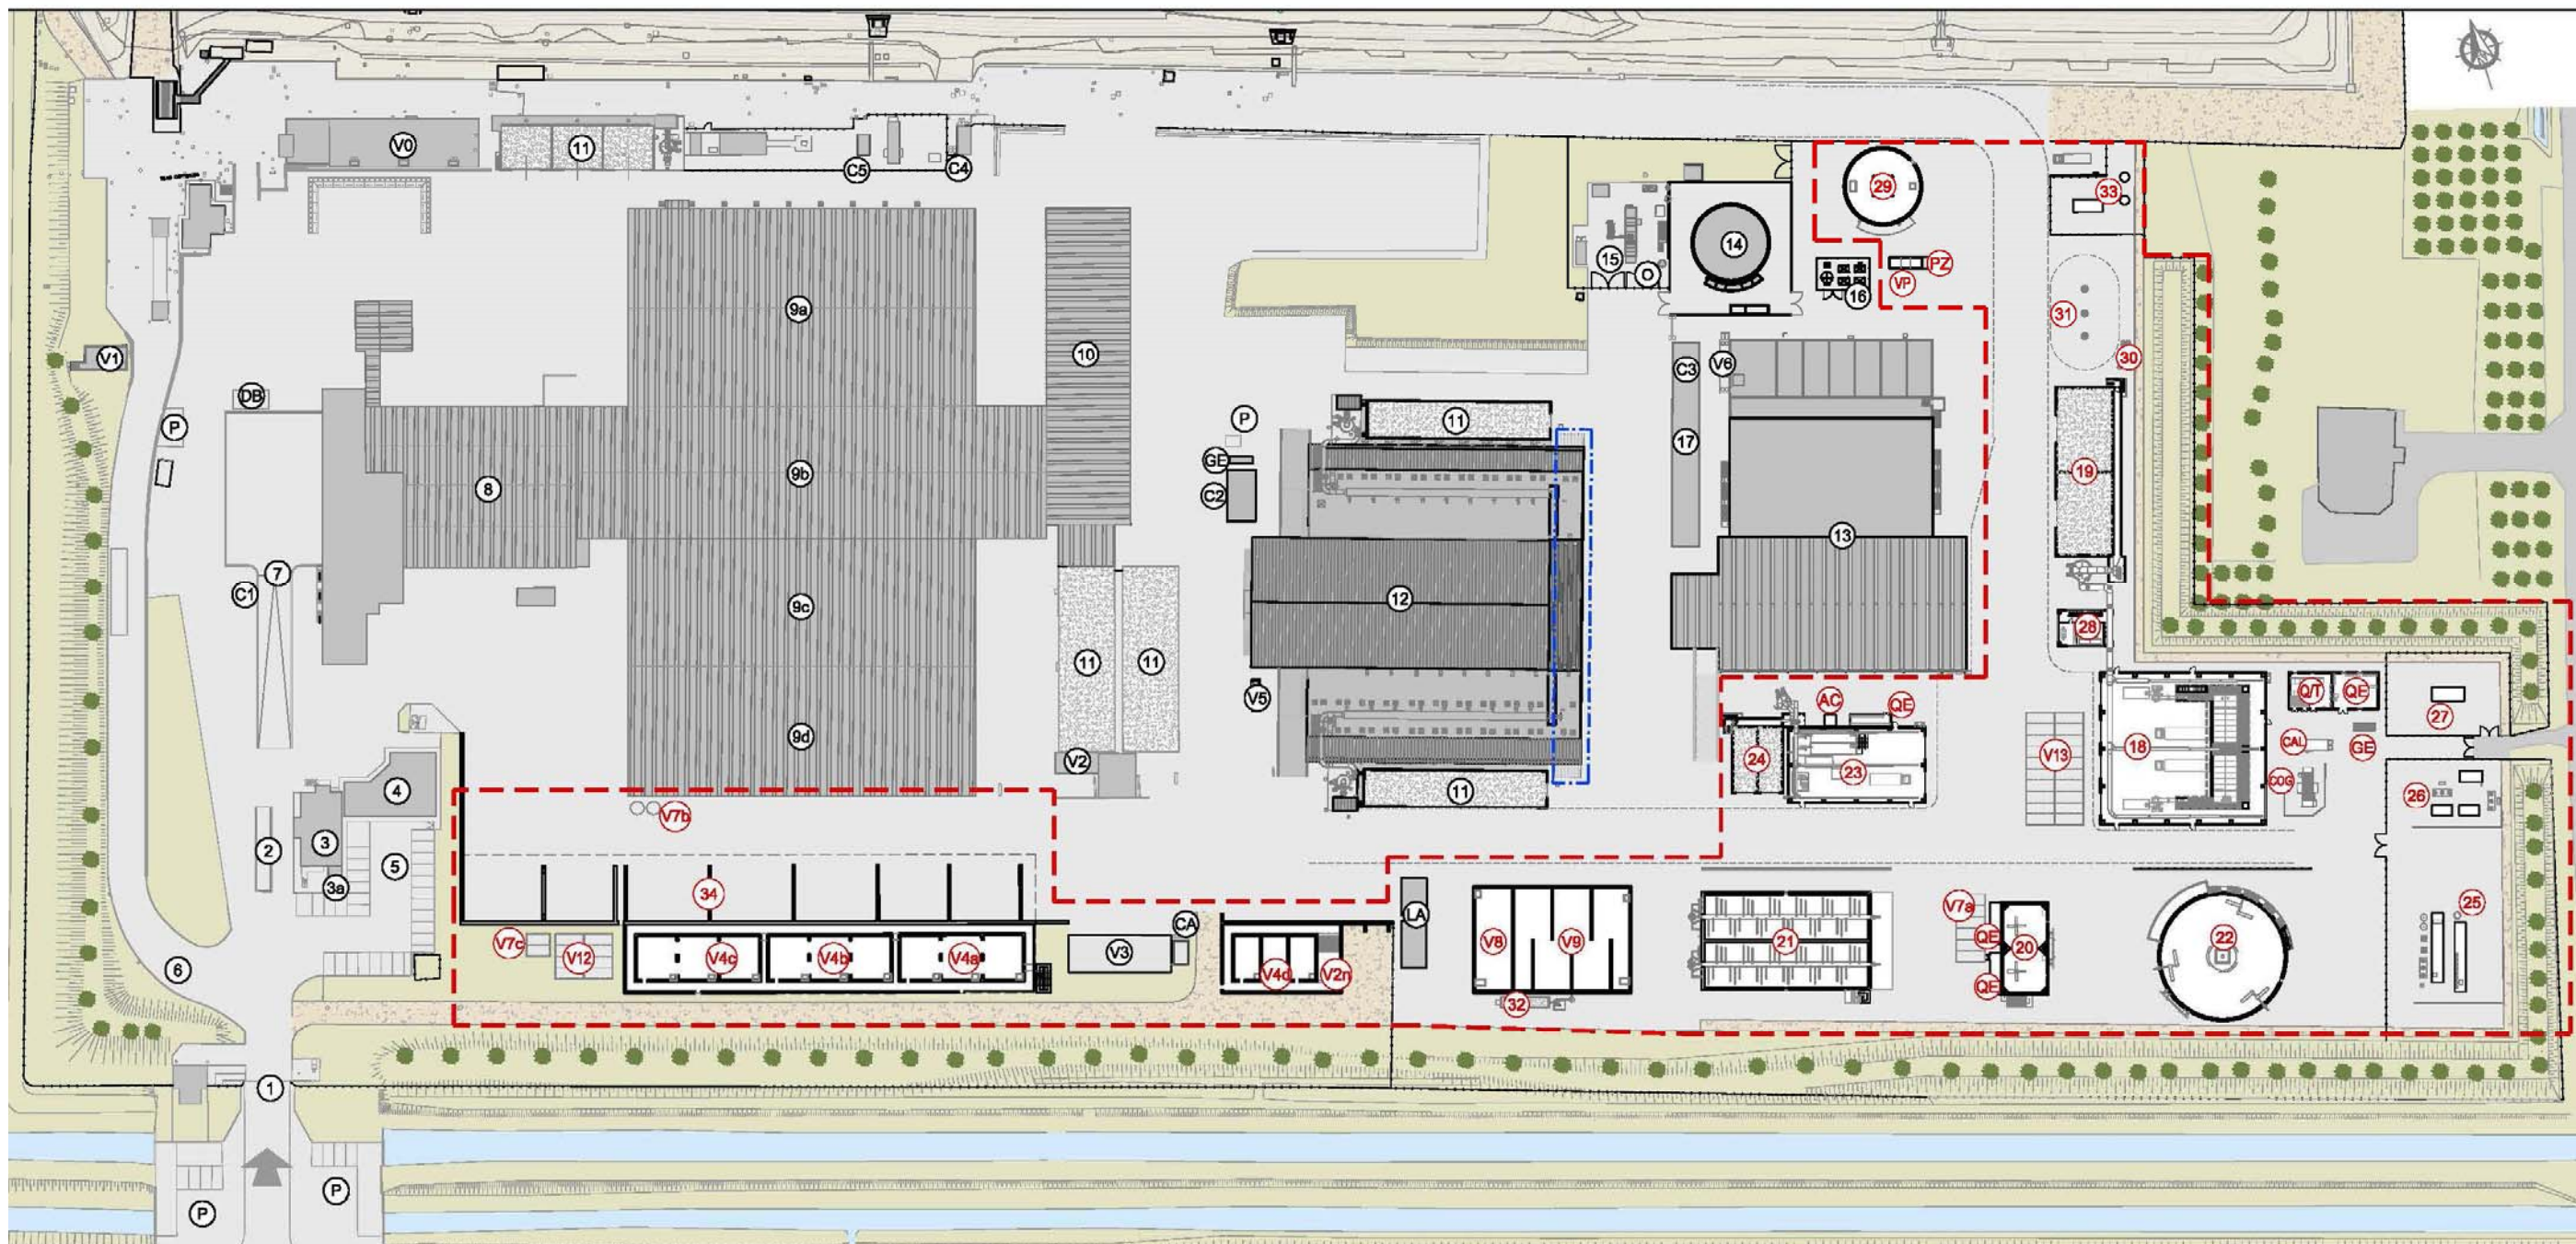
Estratto tavola ARC_002 - Planimetria con indicazione delle principali sezioni impiantistiche di progetto
